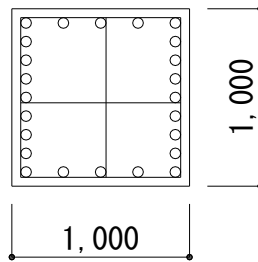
鉄筋コンクリート柱の配筋図 (B1階, 1/B通り) (単位: mm)
